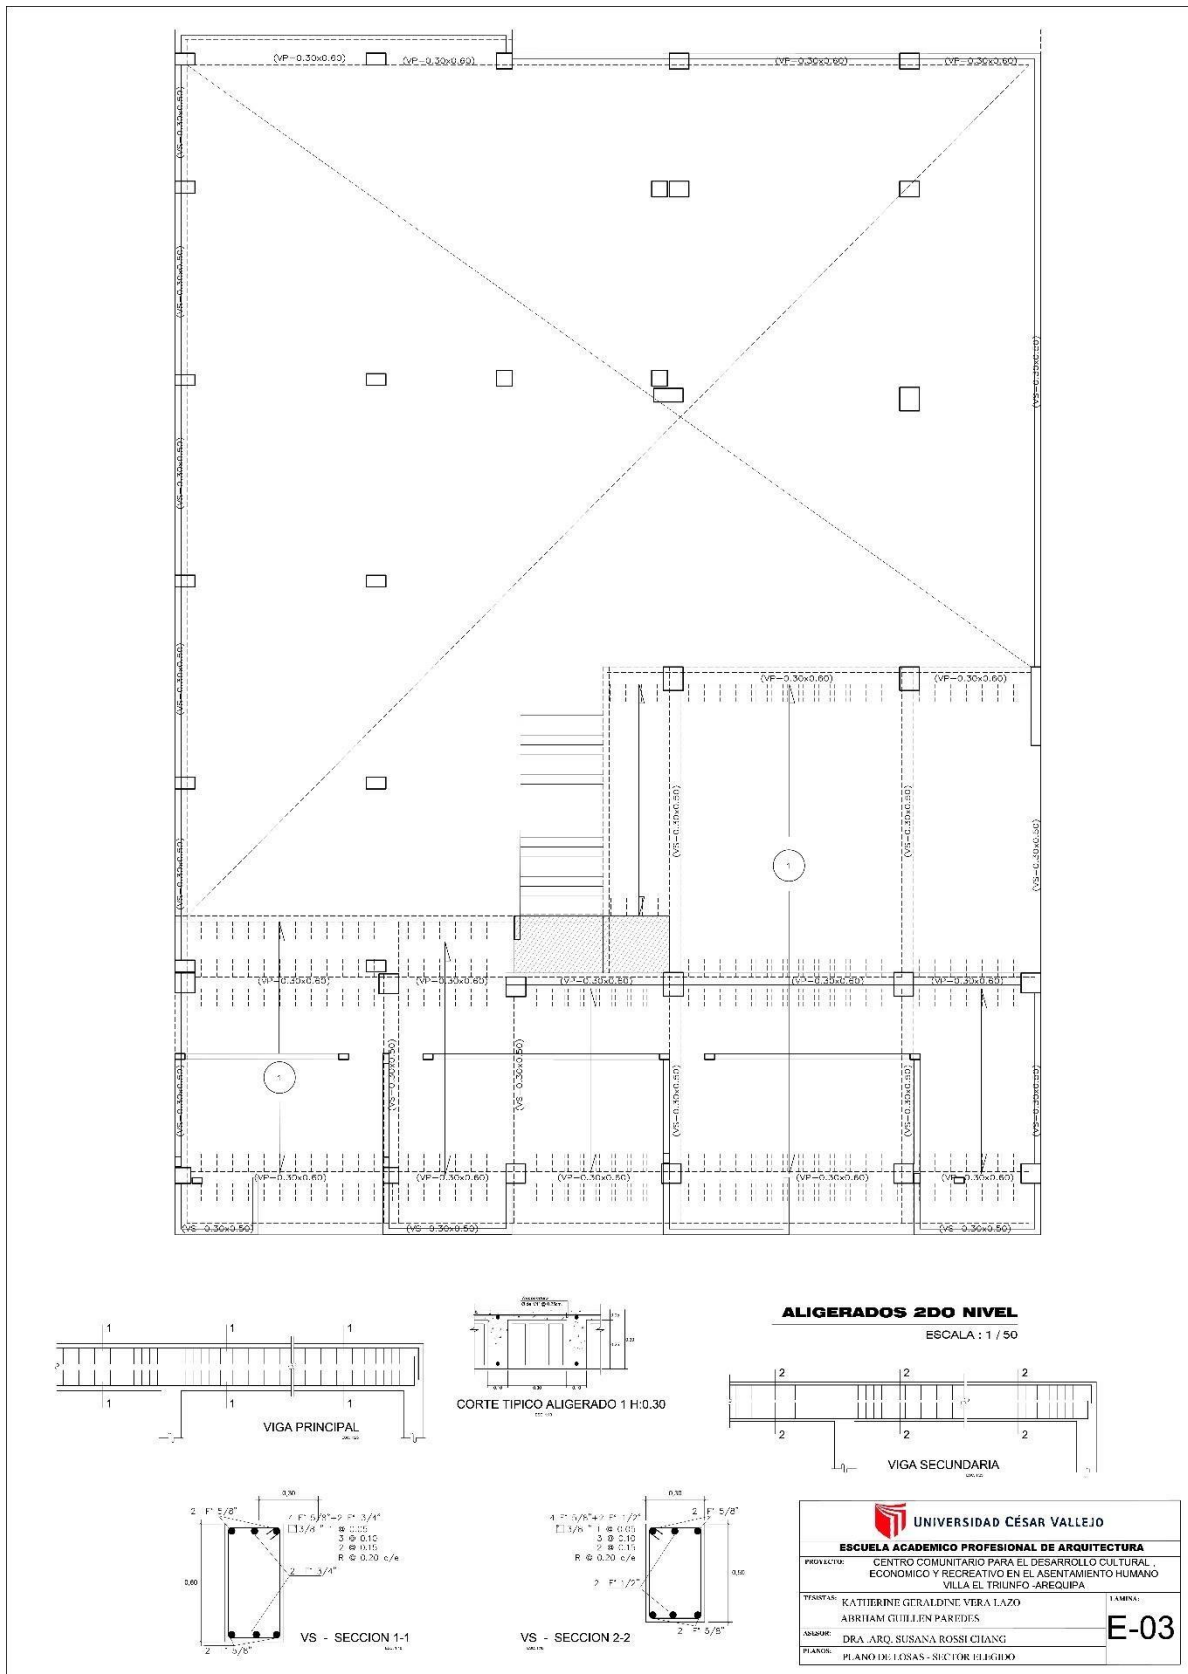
Plano de aligerados Segundo nivel - Elaboración propia
